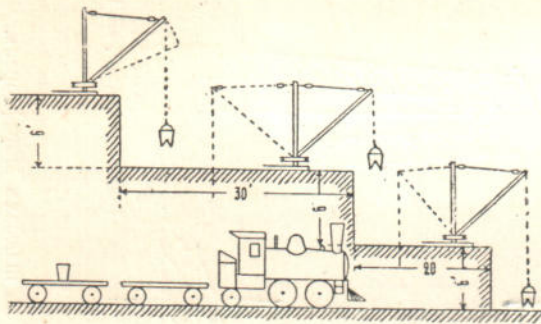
Краны-дерикъ для подачи бетона въ кладку
